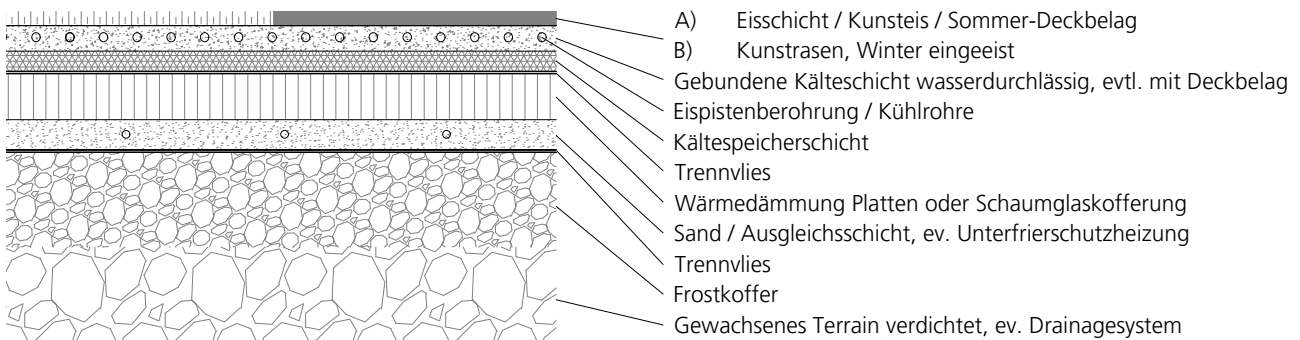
Beispiel Aufbau Kälteschicht auf trockenen und tragfähigen Untergrund, mit Sommersportbelag (wasserdurchlässig)
